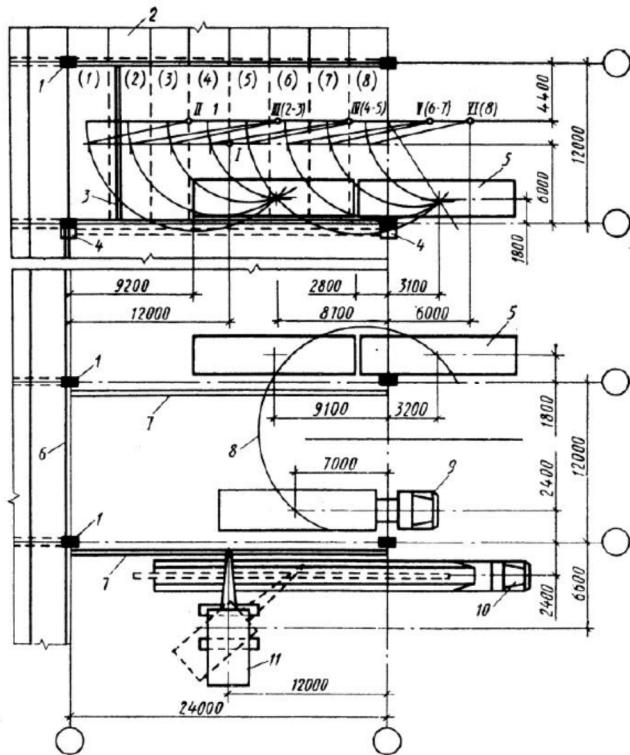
Схема выгрузки, раскладки элементов и монтажа покрытия в пролетах 24 м поперечным методом: 1 - колонна; 2 - смонтированное покрытие; 3 - инвентарная распорка для временного крепления ферм; 4 -телескопическая вышка; 5 - штабель плит; 6 -временное ограждение; 7 - стропильная ферма; 8 - радиус действия крана; 9 - плитовоз; 10 - фермовоз; 11 -кран.
